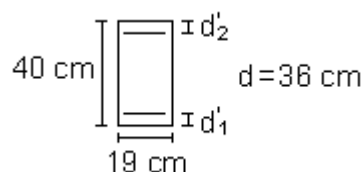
Seção transversal da viga V_3 do Exemplo 4.
